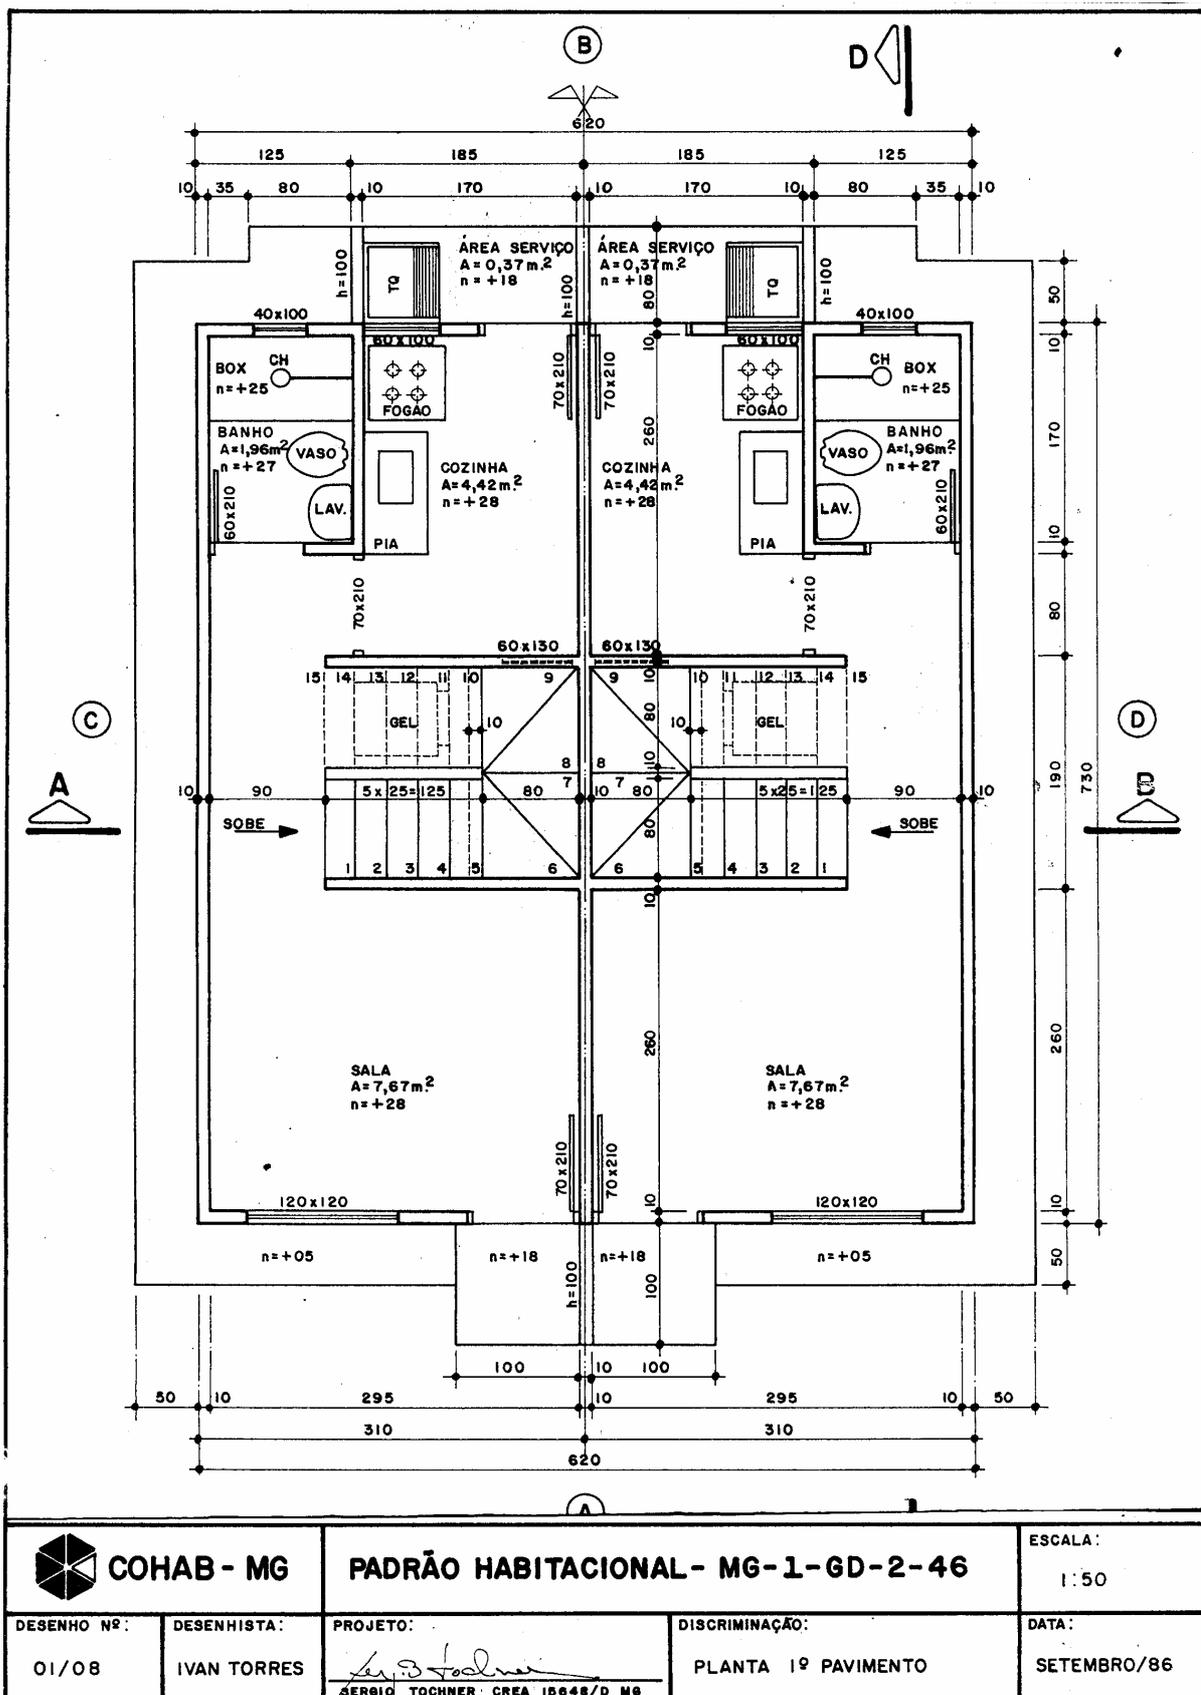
PLANTA BAIXA "PREDINHO" – TÉRREO
